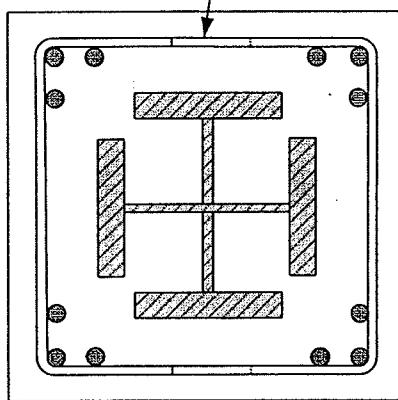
為 SRC 柱的箍筋形狀示意圖；圖 C4.3.7 為 SRC 柱四個角落增加配置繫筋之示意圖[14]，此繫筋可提供主筋固定及柱內混凝土圍束之效果。
